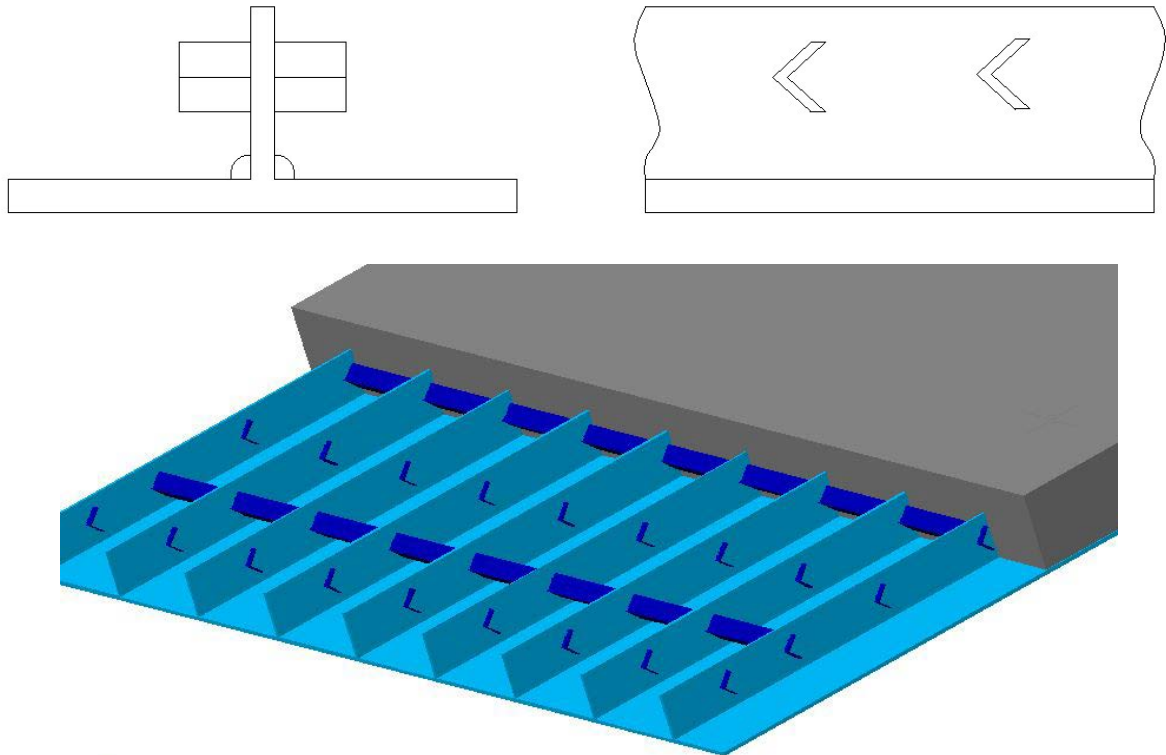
3 – Asigurarea conlucrării între structura de oțel și cea de beton prin conectori
